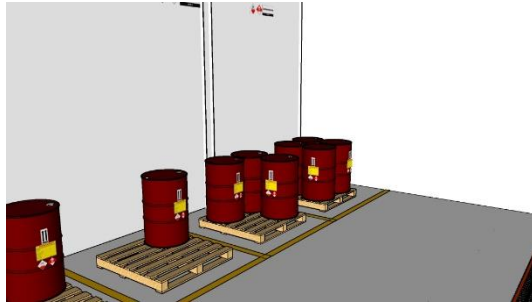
Tampak Depan Bangunan TPS Limbah B3 Gambar
